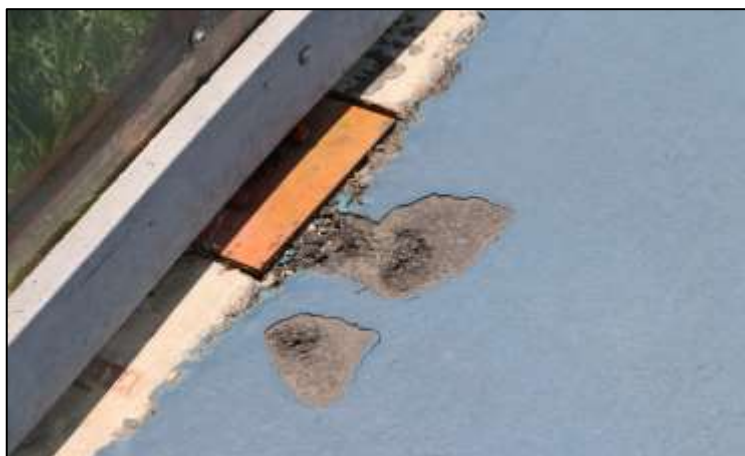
Detalle de la lesión identificada en la imagen anterior. Según el flexómetro utilizado, la abertura de la fisura no supera los 2 milímetros.
